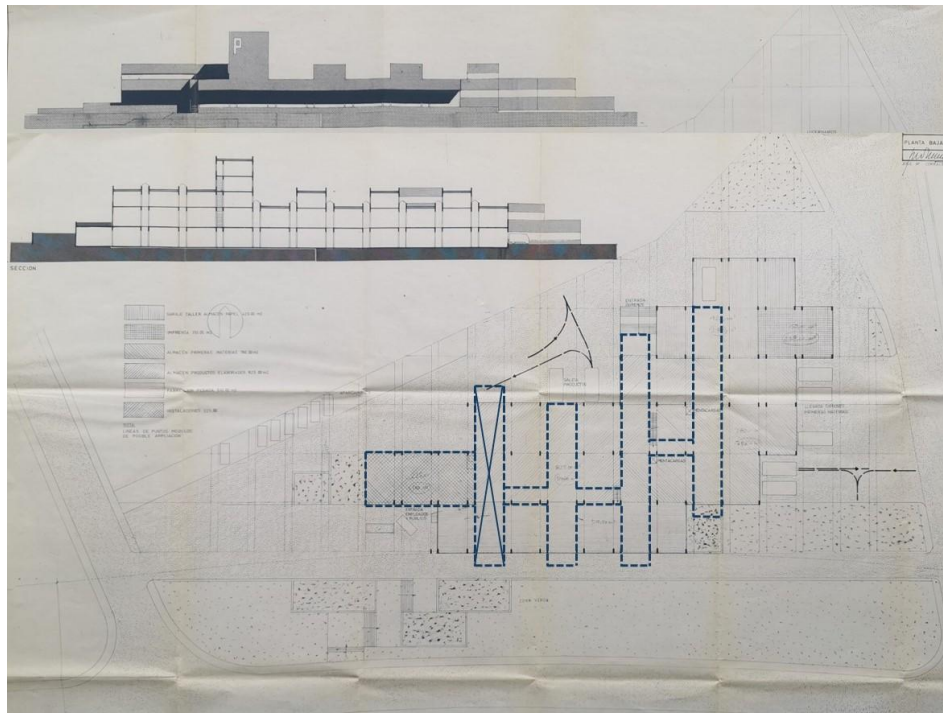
Solución 2. Planta baja con sección y alzado sur (VM/p190/J9-2). En azul, indicación de pabellones (autor). Norte arriba.
